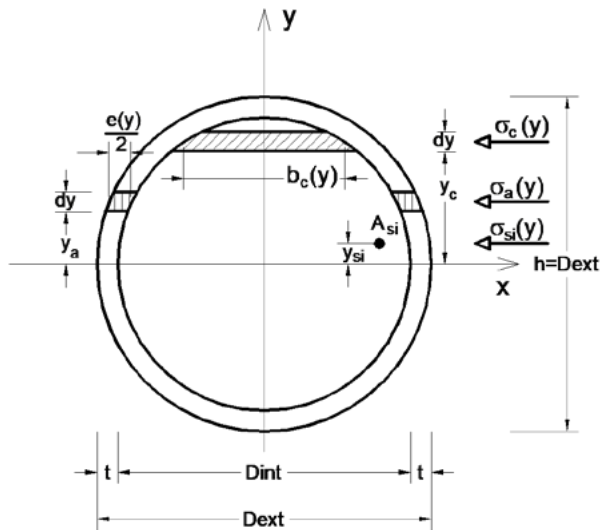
Sección transversal del tubo mixto acero-hormigón.
